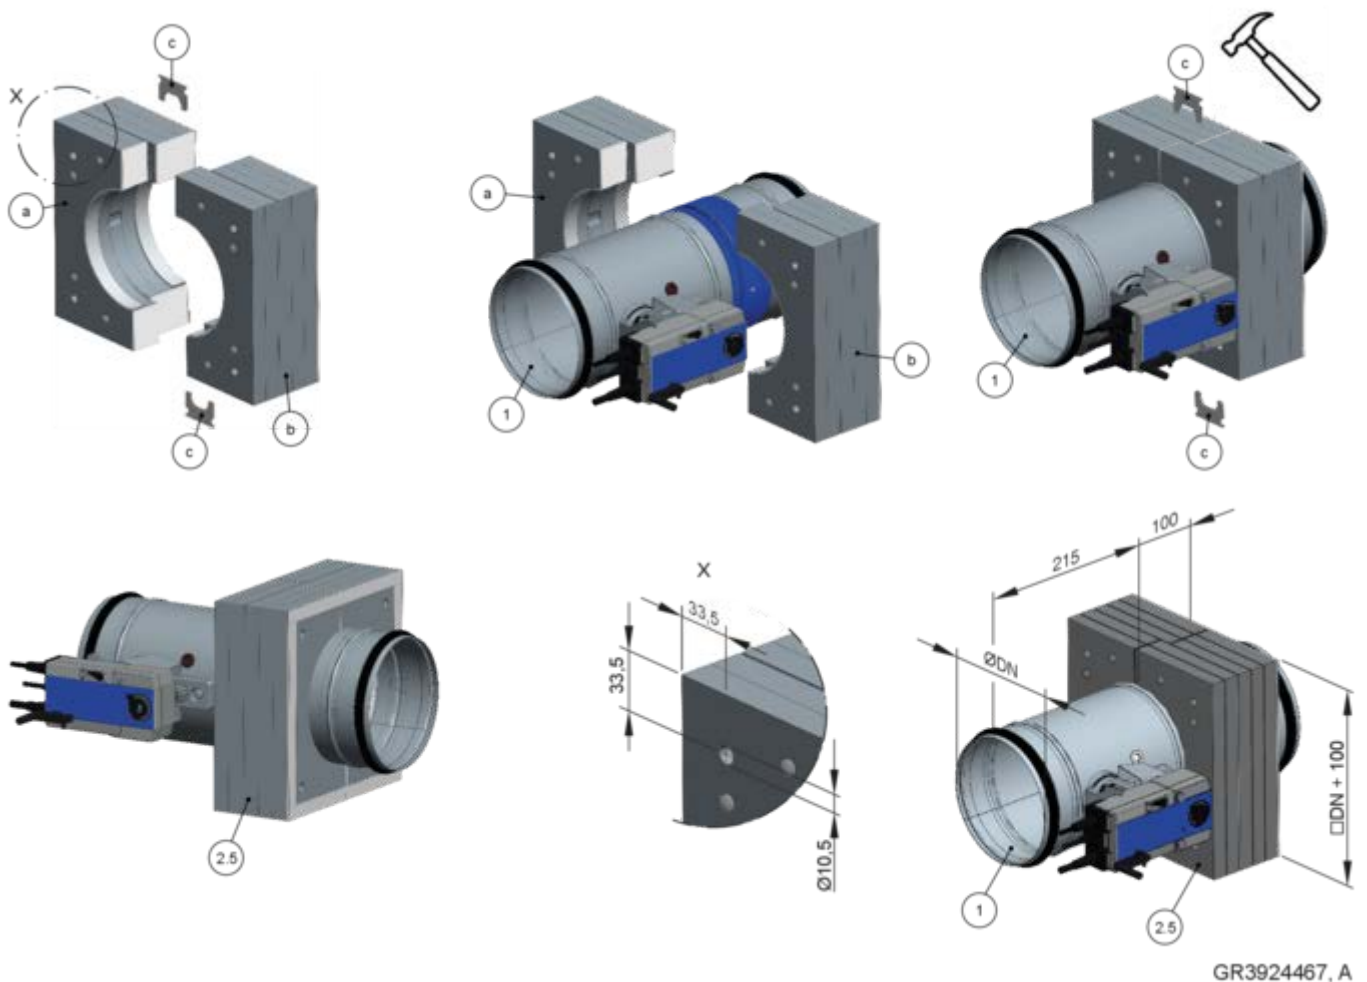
Leveranspaket och installation av installationskit GL2 för torr installation utan murbruk
